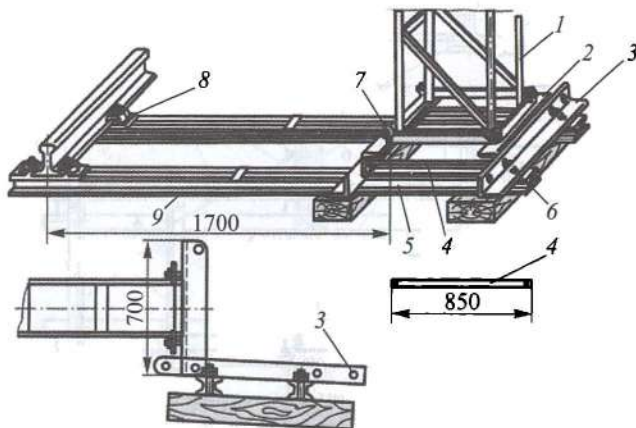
Конструкция швеллерного «фундамента» с креплением под рельс:
